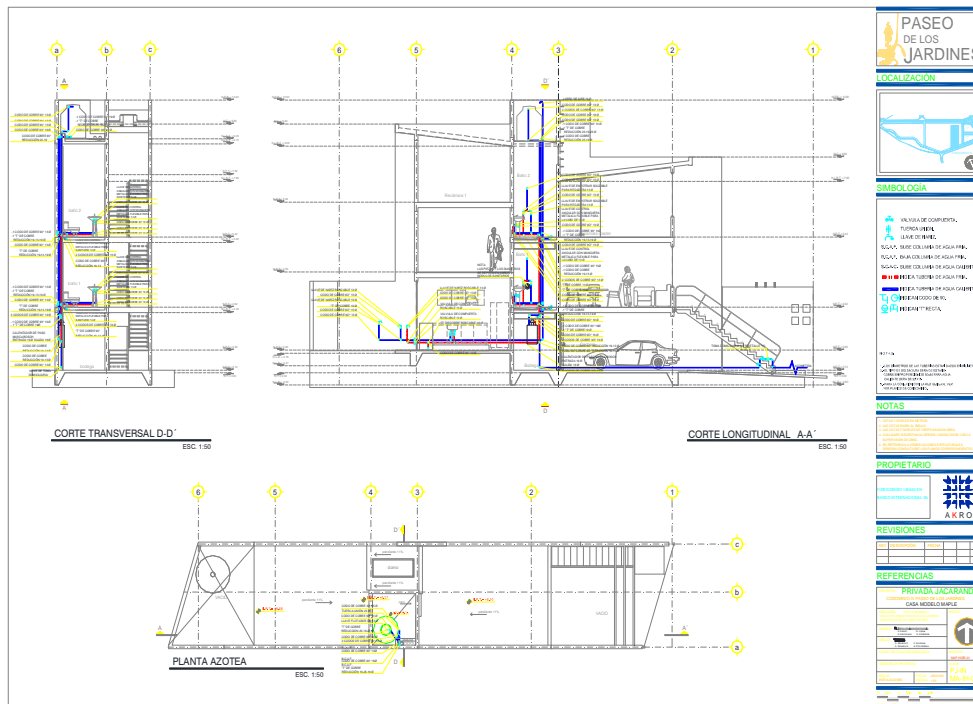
Instalación hidráulica Cortes y Planta Azotea
